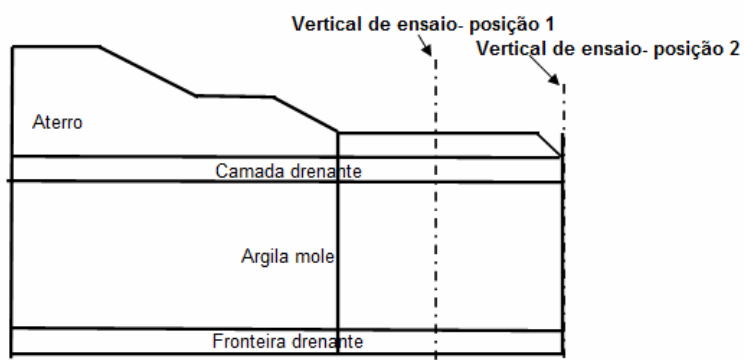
Desenho esquemático da posição das verticais de ensaios de palheta e piezocone.
